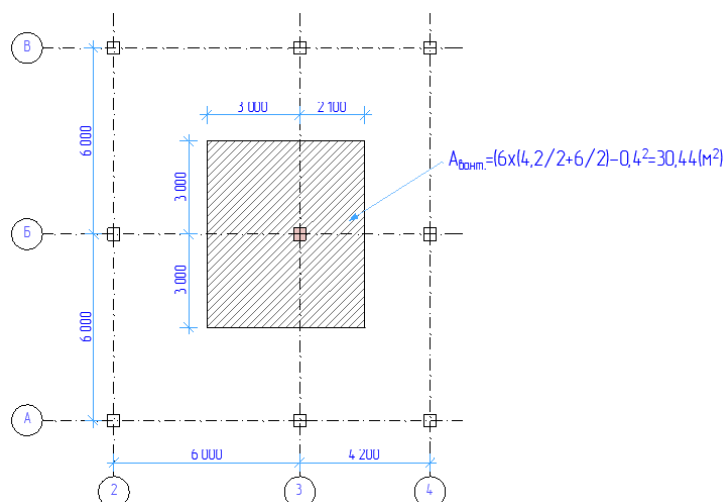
План будівлі з визначеною зоною вантажної площі
